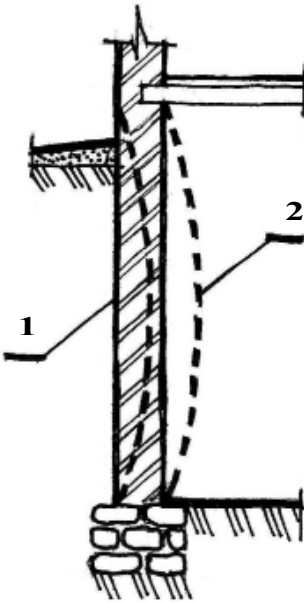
Деформація стіни фундаментно-підвальної частини (ФПЧ) будівлі внаслідок втрати міцності кладки стіни, додаткового завантаження поверхні землі безпосередньо біля будівлі, морозного набрякання ґрунту при неправильному утриманні підвального приміщення будівлі:
